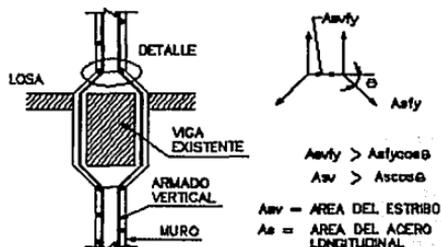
Detalle de la continuidad del armado vertical en un muro de rigidez.
